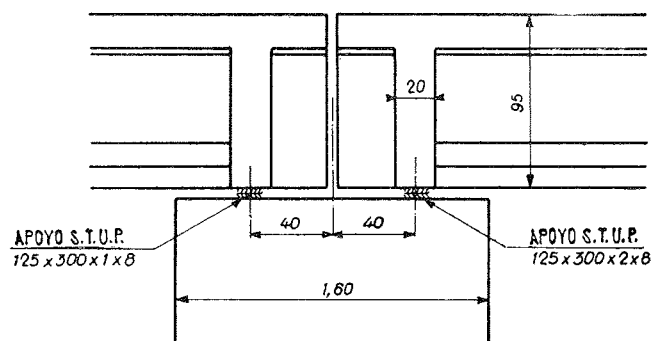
Apoyos del puente sobre el río Vie, entre Saint-Gilles y Croix-de-Vie.
